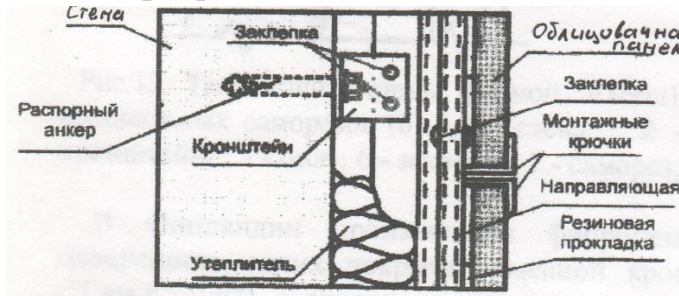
Теплозащита стены бизнес-центра на Садовнической набережной в г. Москве (фирма "ТНКА", Турция)
